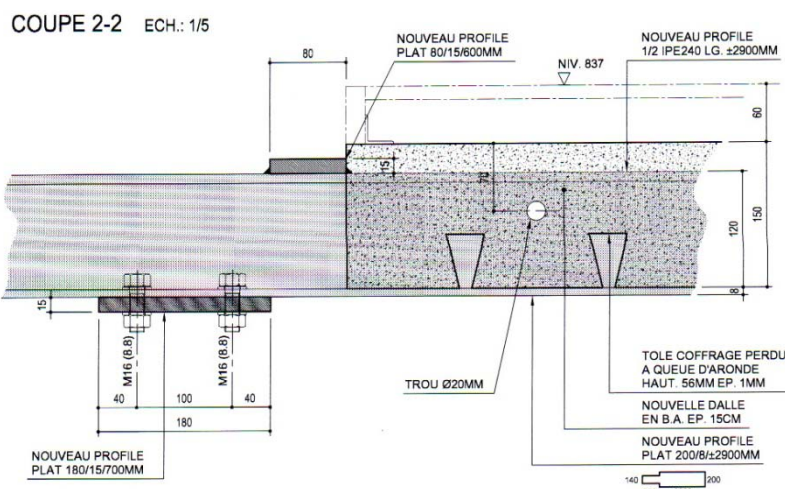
La dalle coulée sur les tôles de coffrage avec les IPE visibles en partie. (Plans-d'exécution, 2007)
